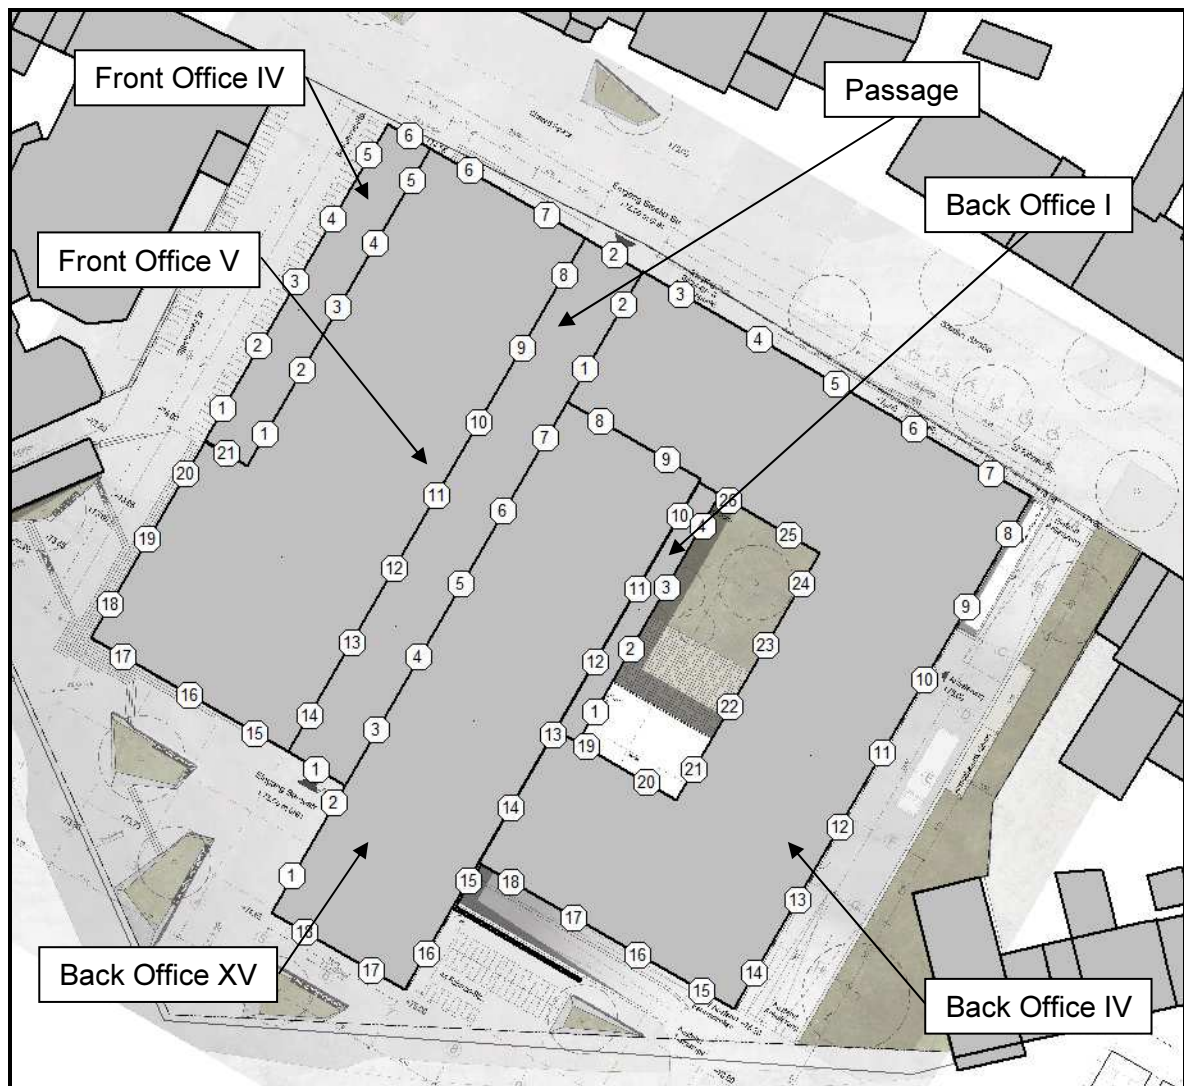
Lage und Kennzeichnung der Fassadennummerierungen
